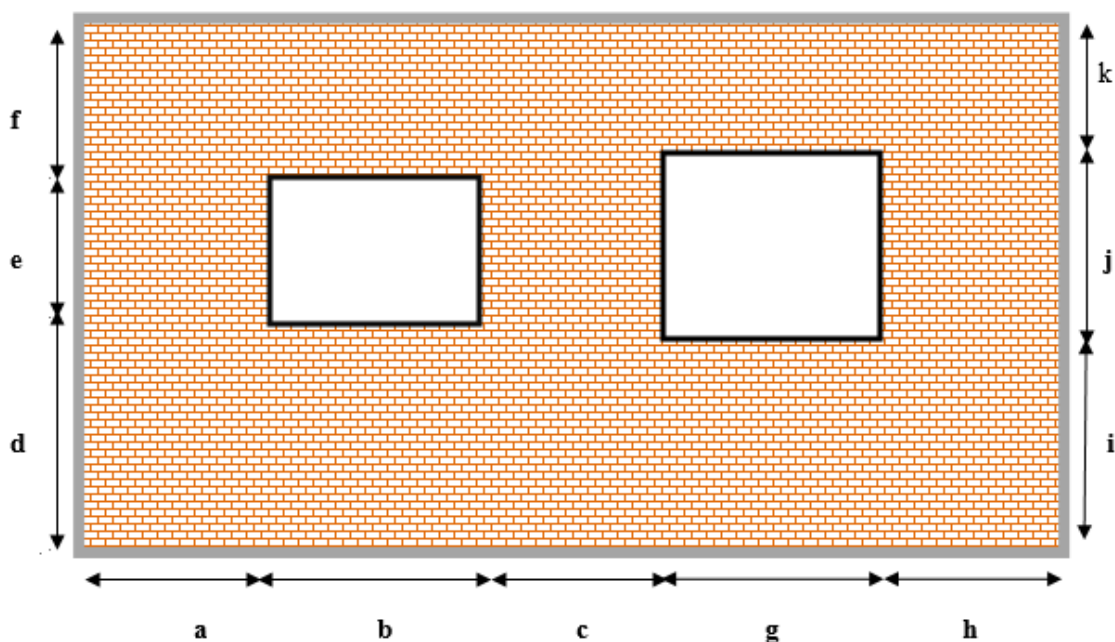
Parede de alvenaria de enchimento de pórtico de betão armado e parâmetros medidos para identificação de tipologias de parede.
